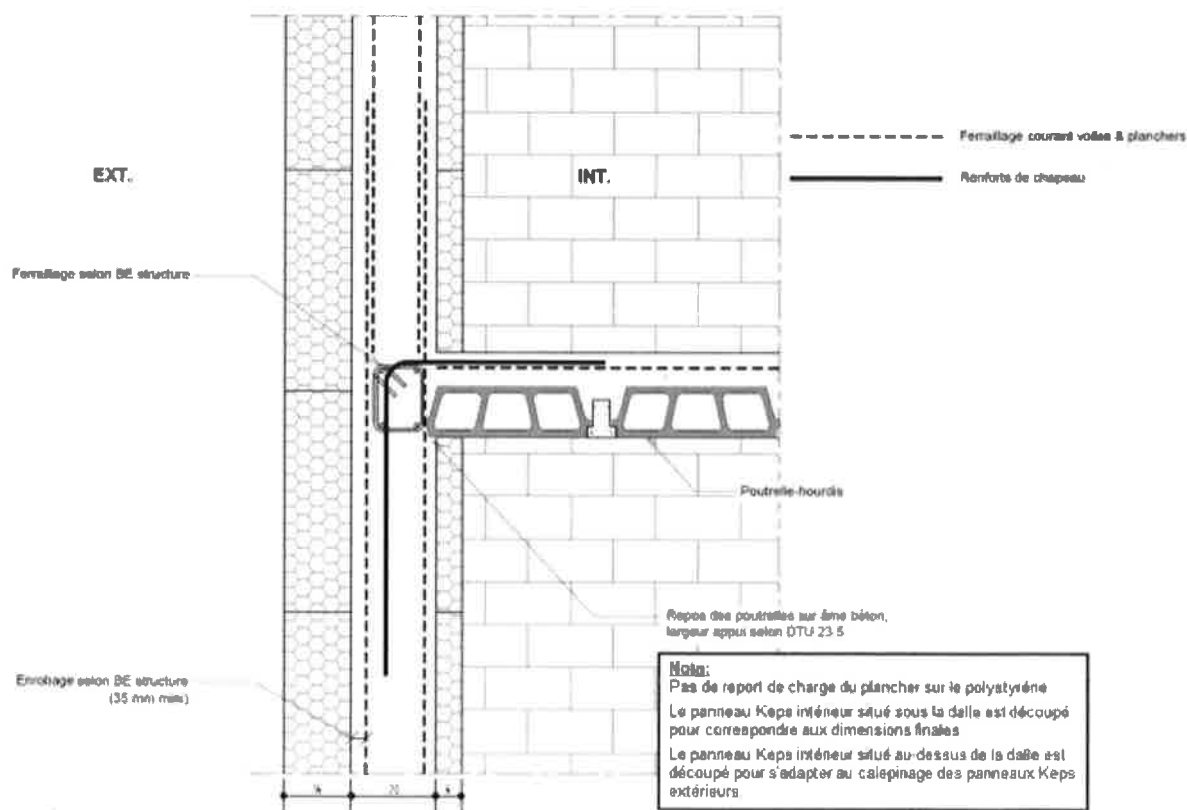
liaison mur-plancher à poutrelles (sens transversal)
